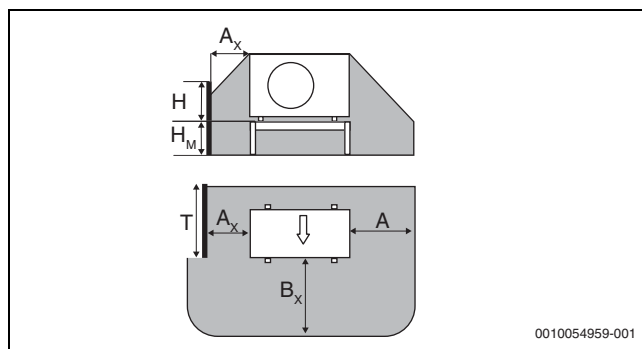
Area di sicurezza con barriera a sinistra, pompa di calore su supporto da pavimento
